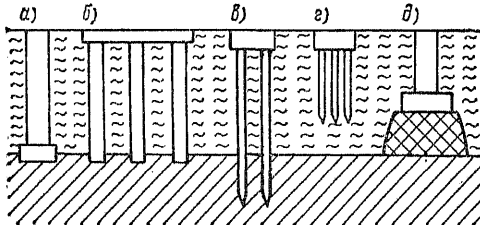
Варианты устройства фундаментов при напластовании грунтов по схеме II
